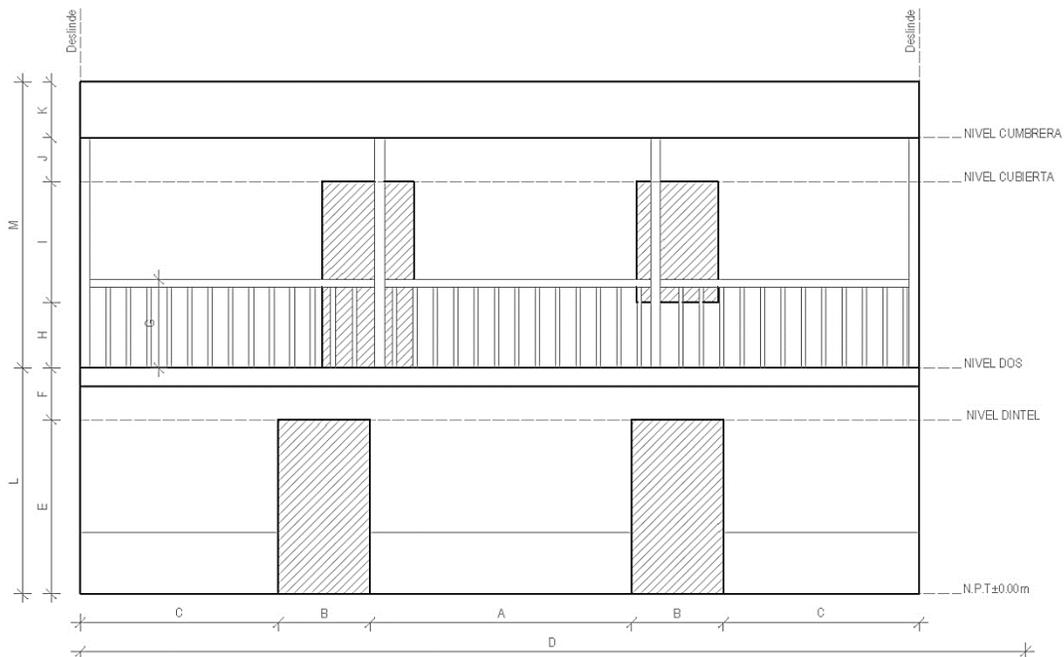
Ejemplos en elevación de variables que definen la tipología A1. Elab. Propia.
